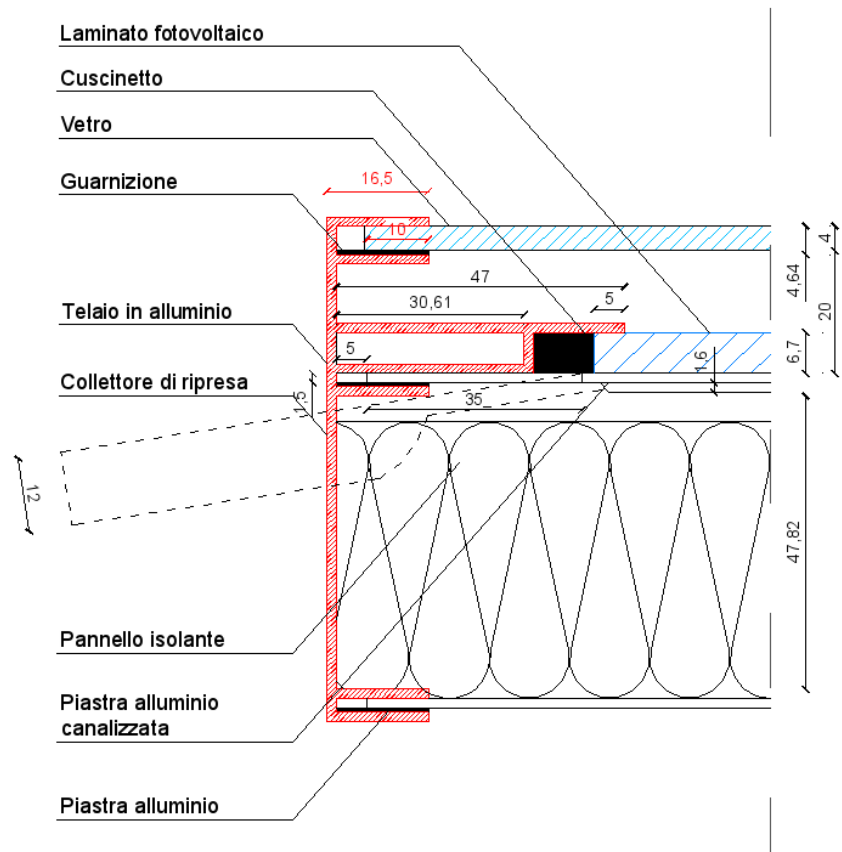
Sezione Longitudinale del telaio di chiusura.
